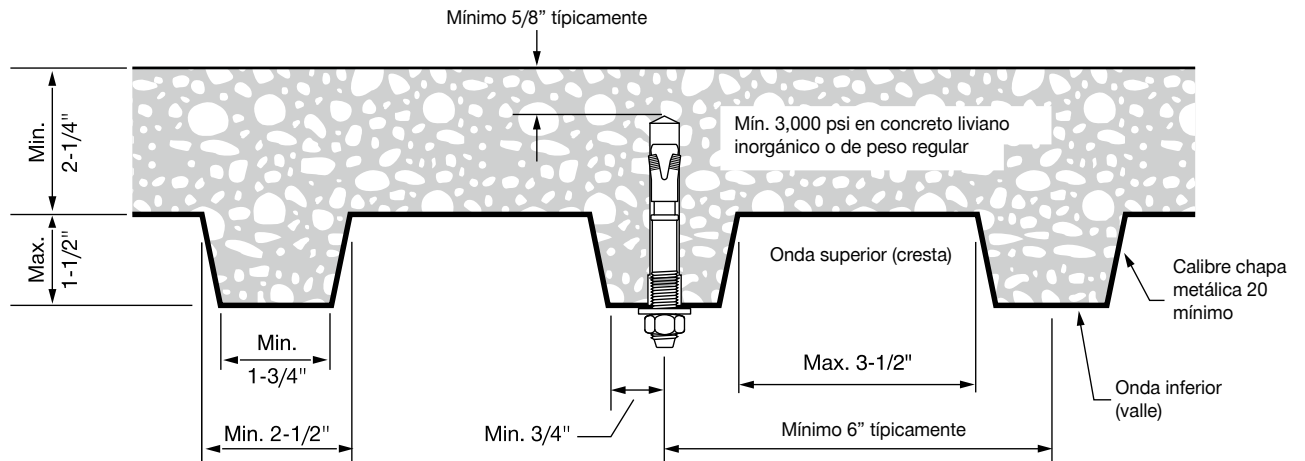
Instalación de Kwik Bolt TZ en losas compuestas sobre chapa metálica - Losa B
